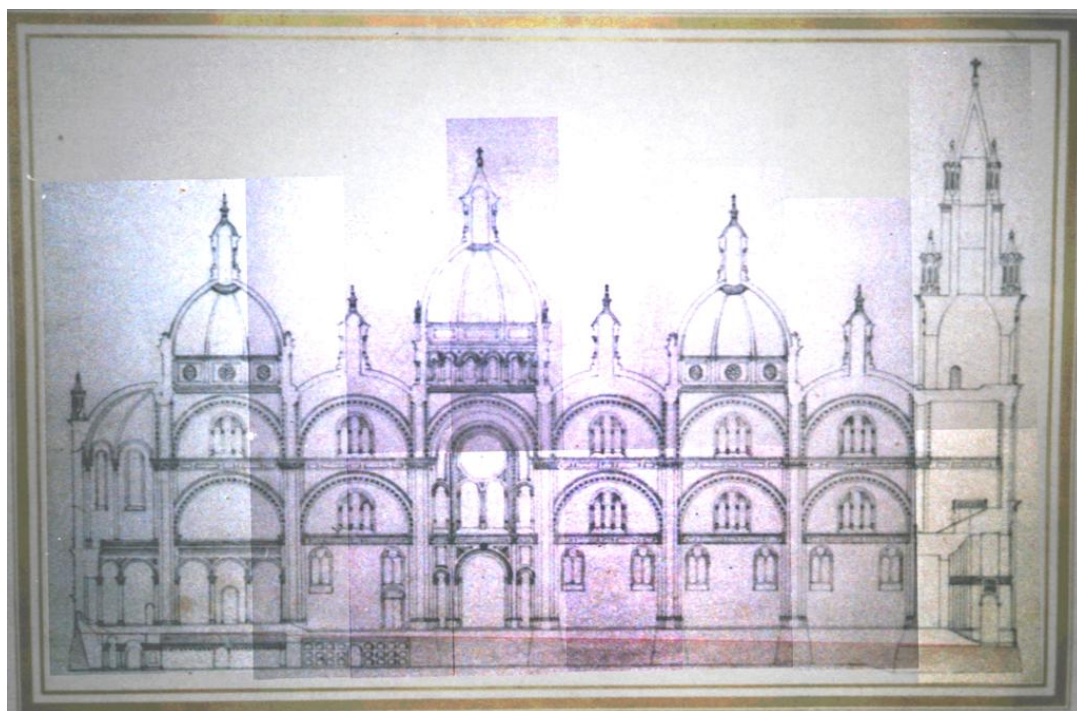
Imagen del plano original de donde se dedujo las características de la cimentación.
